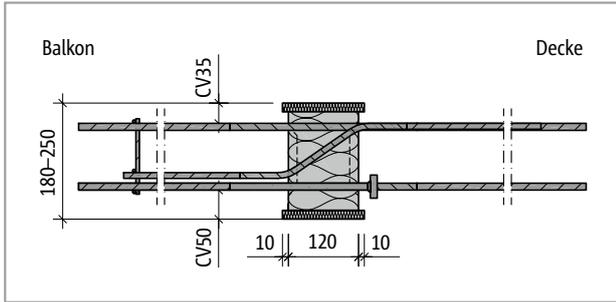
Schöck Isokorb® XT Typ C-L-CV35: Produktschnitt
